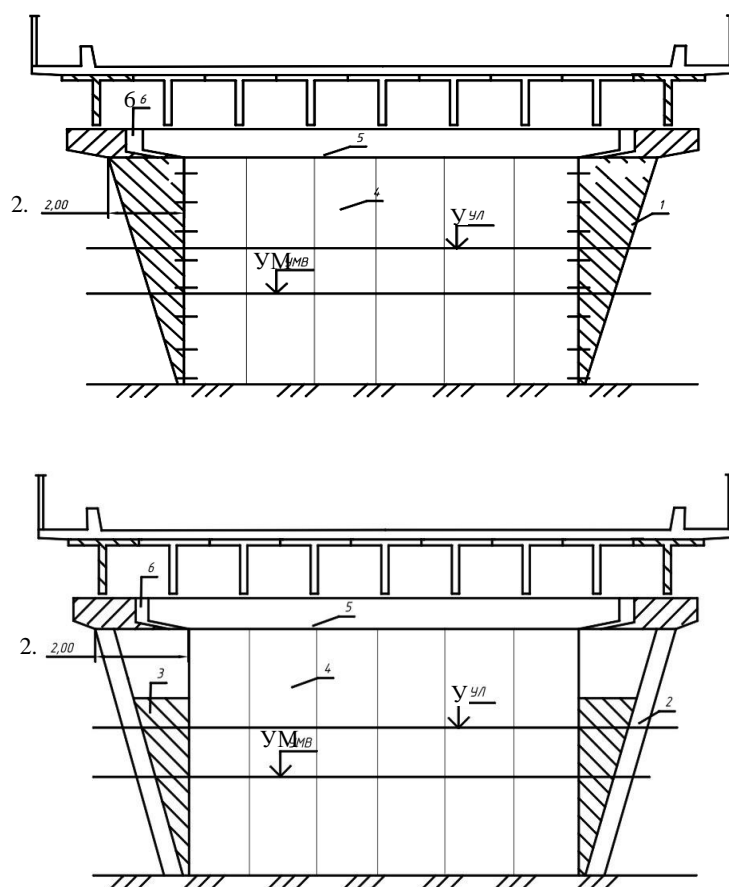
Уширение опор-стенок: а) – уширение сплошным массивом железобетона; б) – уширение с опиранием насадки на подкосы; $Y_{Л}$ – уровень высокого ледохода;
